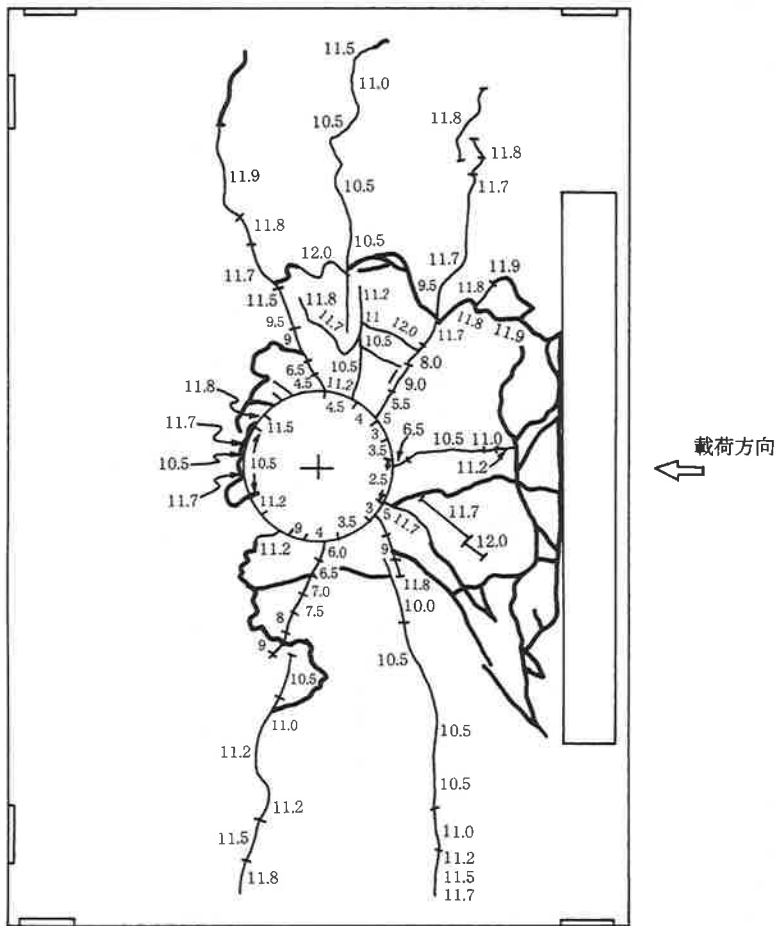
フーチング下面・側面ひび割れ発生状況 (B-11)
